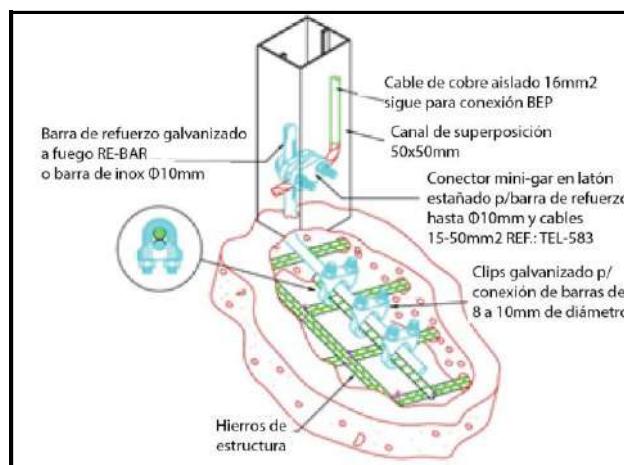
Amarre de los herrajes de la Platea con barra galvanizada
